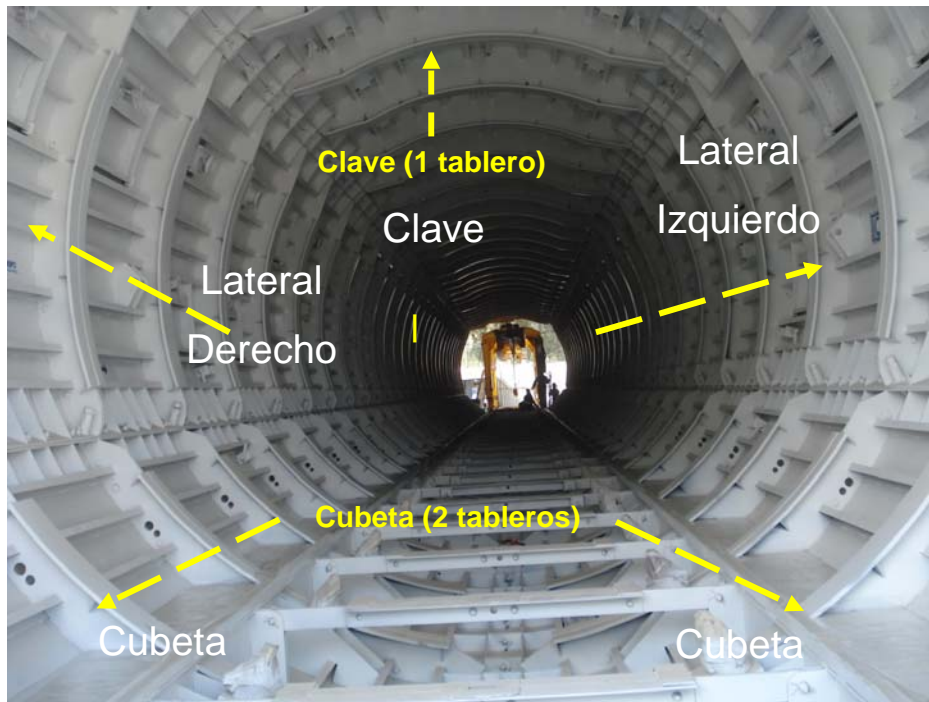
Tableros de la Cimbra metálica telescópica.
